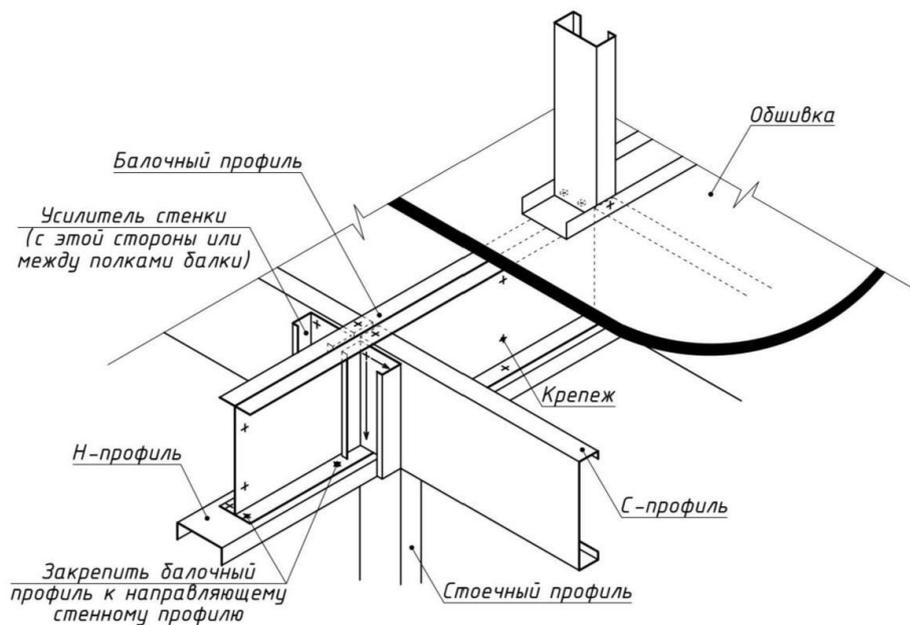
Схема креплений перекрытий к внутренним несущим стенам
